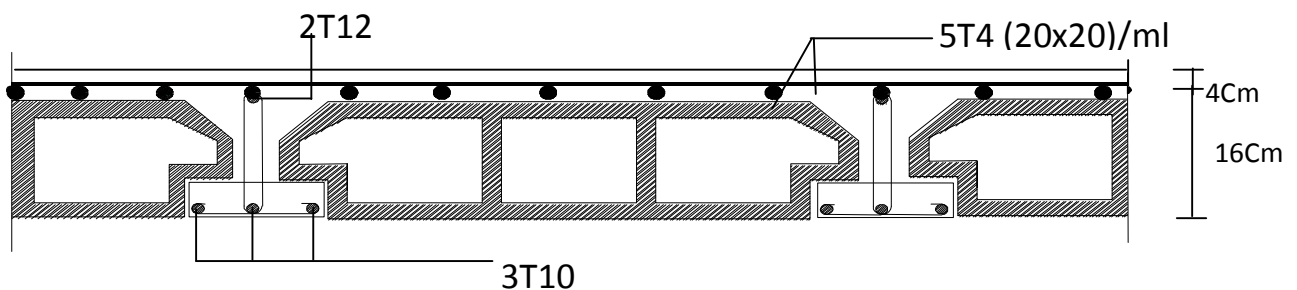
Plan de ferrailage du plancher en corps creux.
